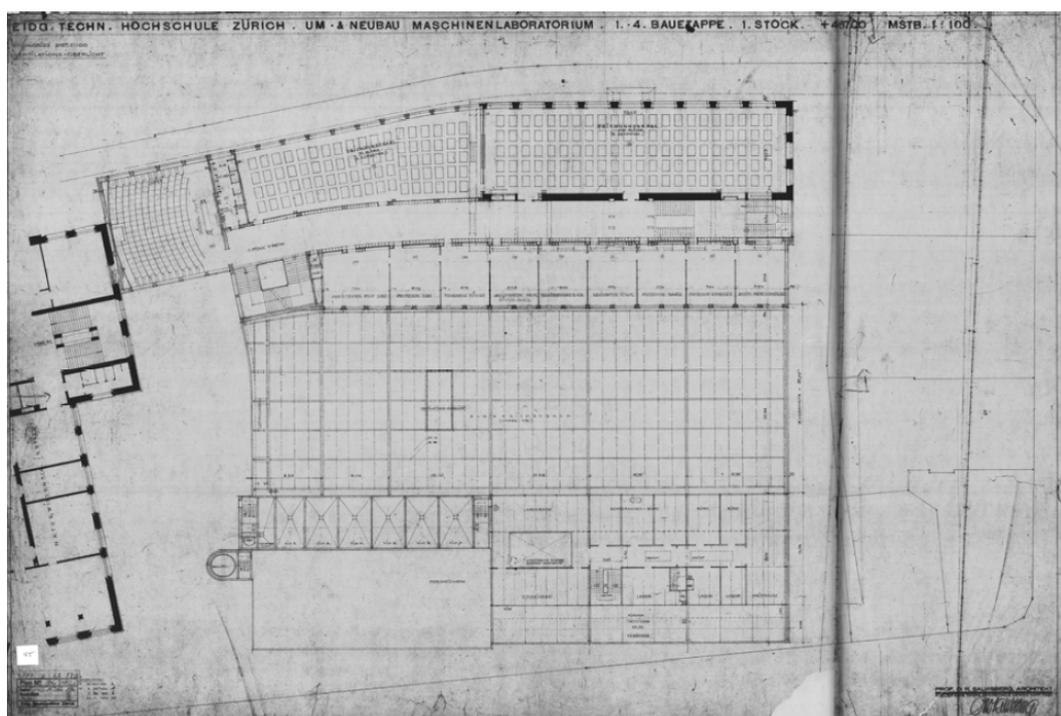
Projektplan Maschinenlaboratorium, Grundriss Geschoss H (Prof. O. R. Salvisberg, 1931)
